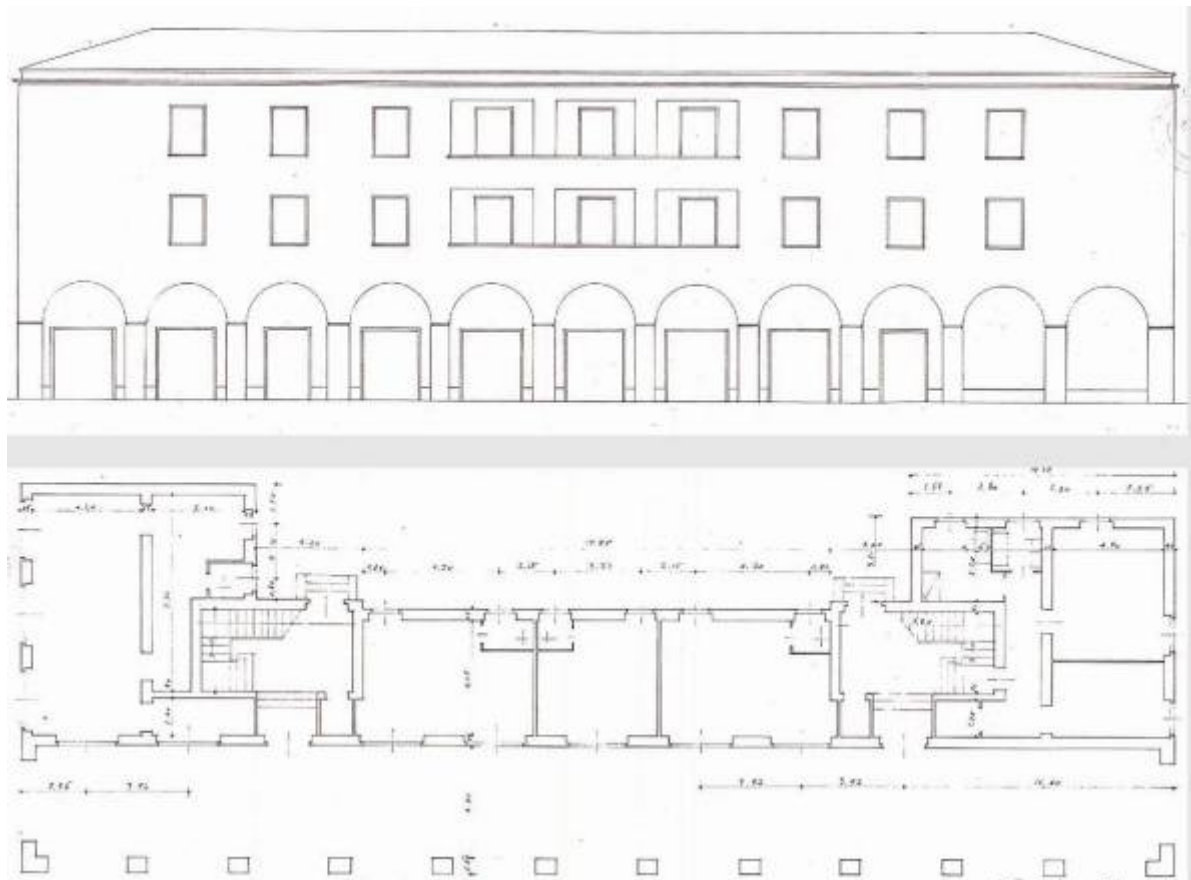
Case I.N.C.I.S. – Prospetto e pianta PT palazzina Sud-Ovest rispetto alla via Pola.
